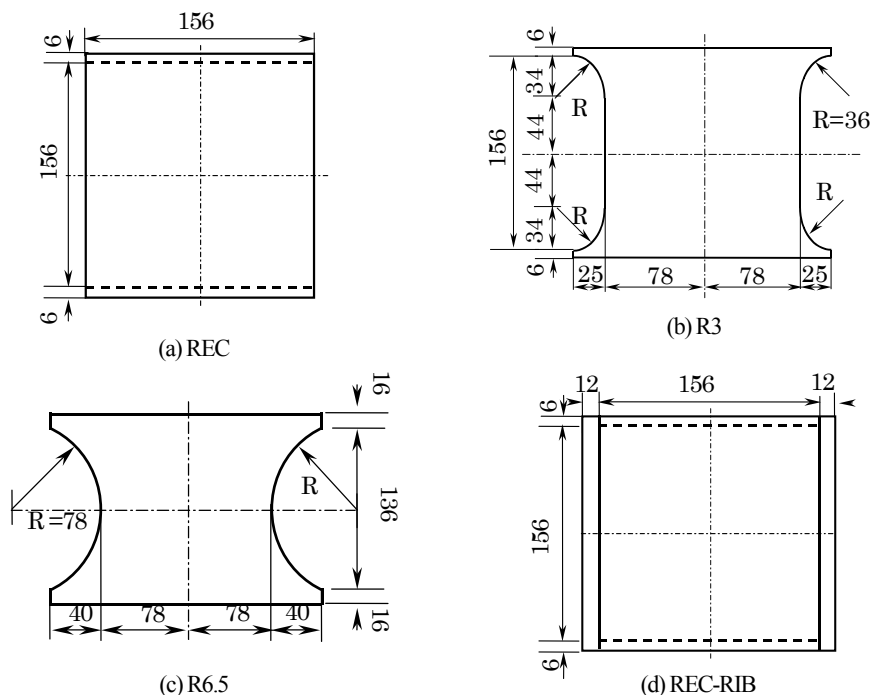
試験体の形状寸法および記号 (寸法の単位 mm)
